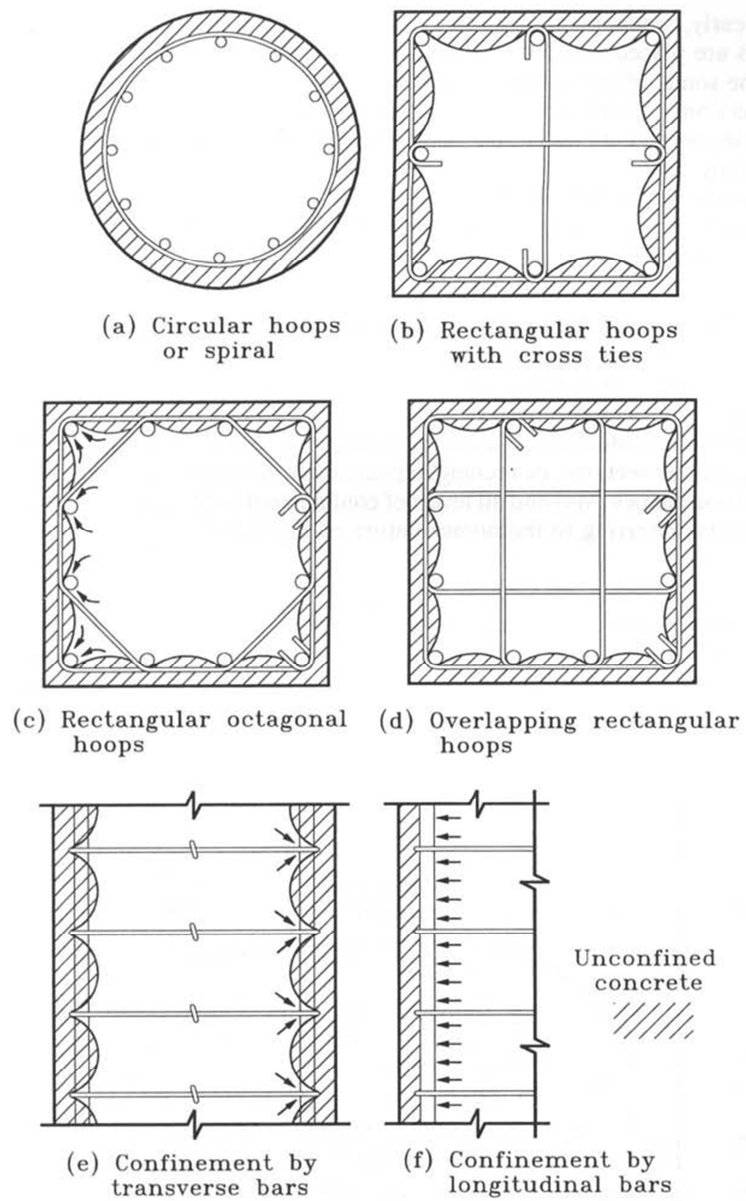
Confinamiento de secciones de columna con refuerzo transversal y longitudinal (Tomado de Priestley, Seible y Calvi, 1996)
